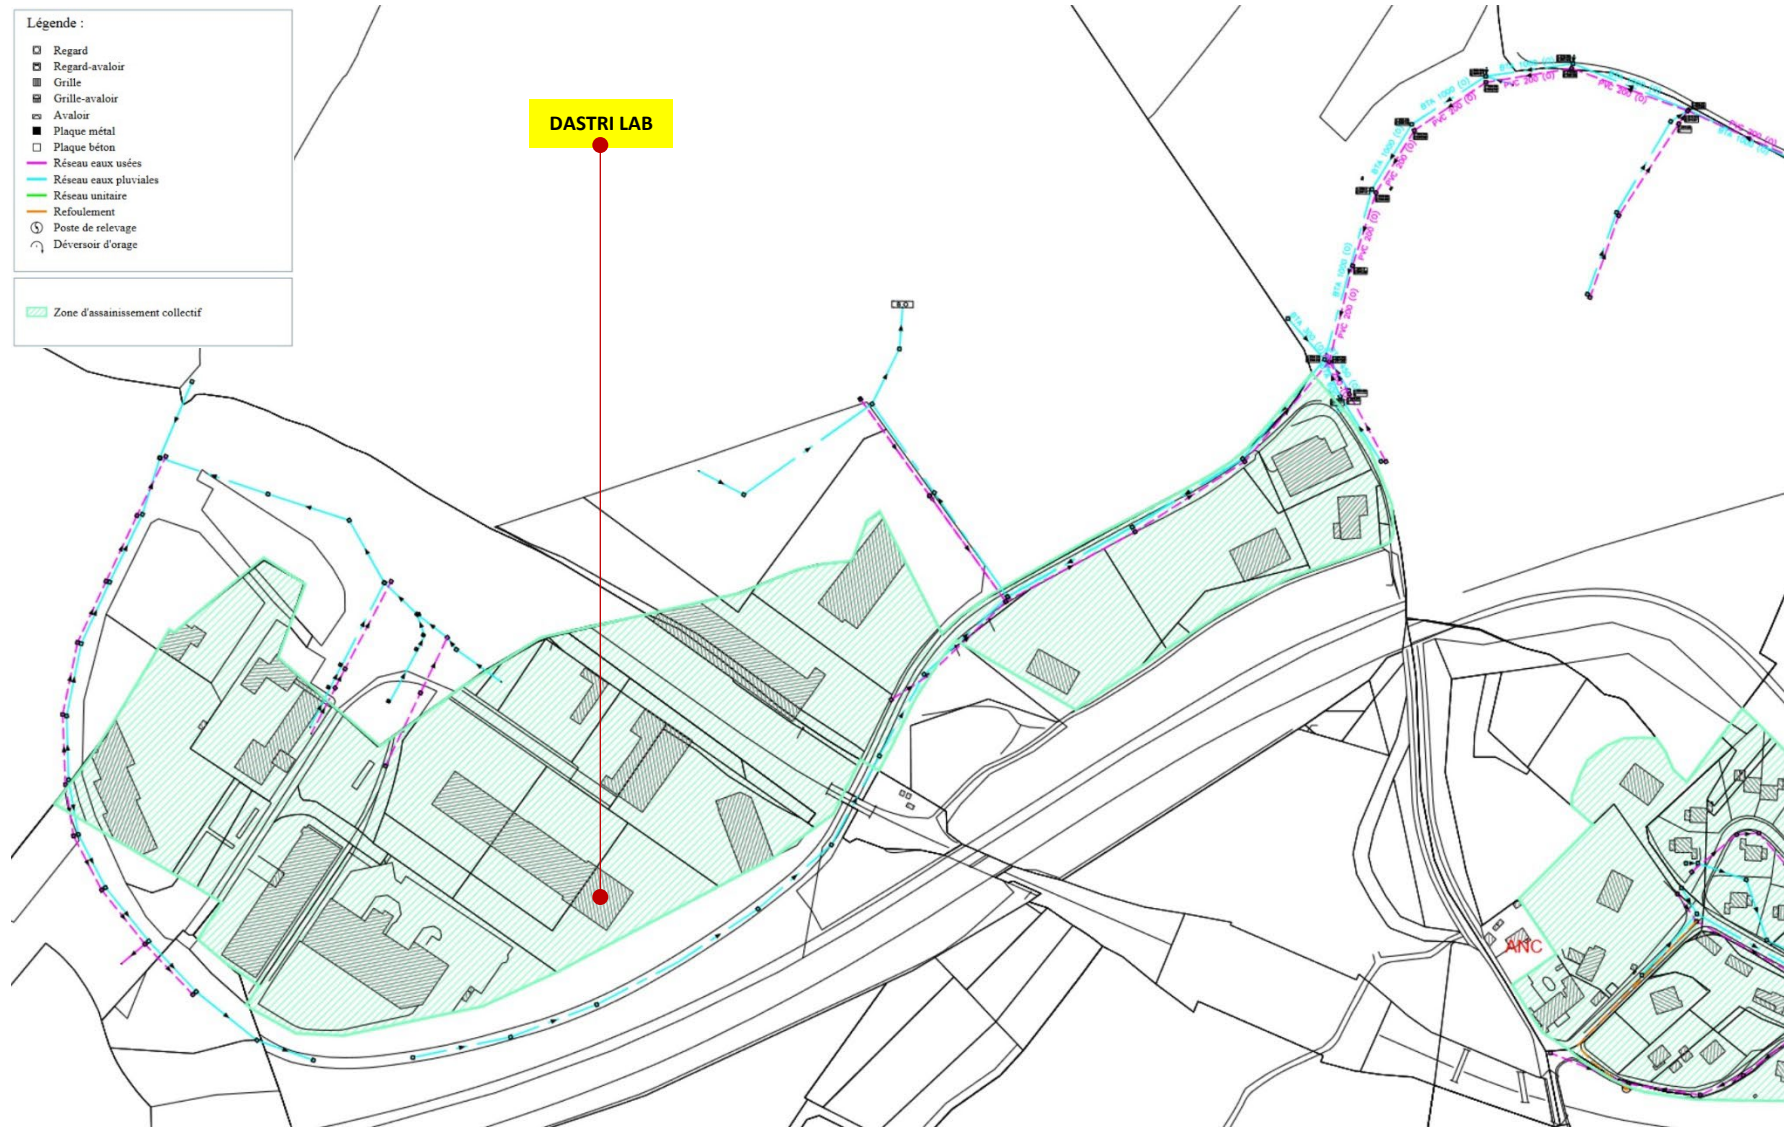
Zone et réseaux d'assainissement collectif de la ZAC d'implantation de DASTRI LAB
